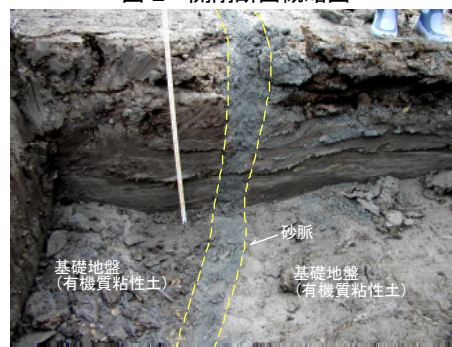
基礎地盤内の亀裂(脈状に挟在)
